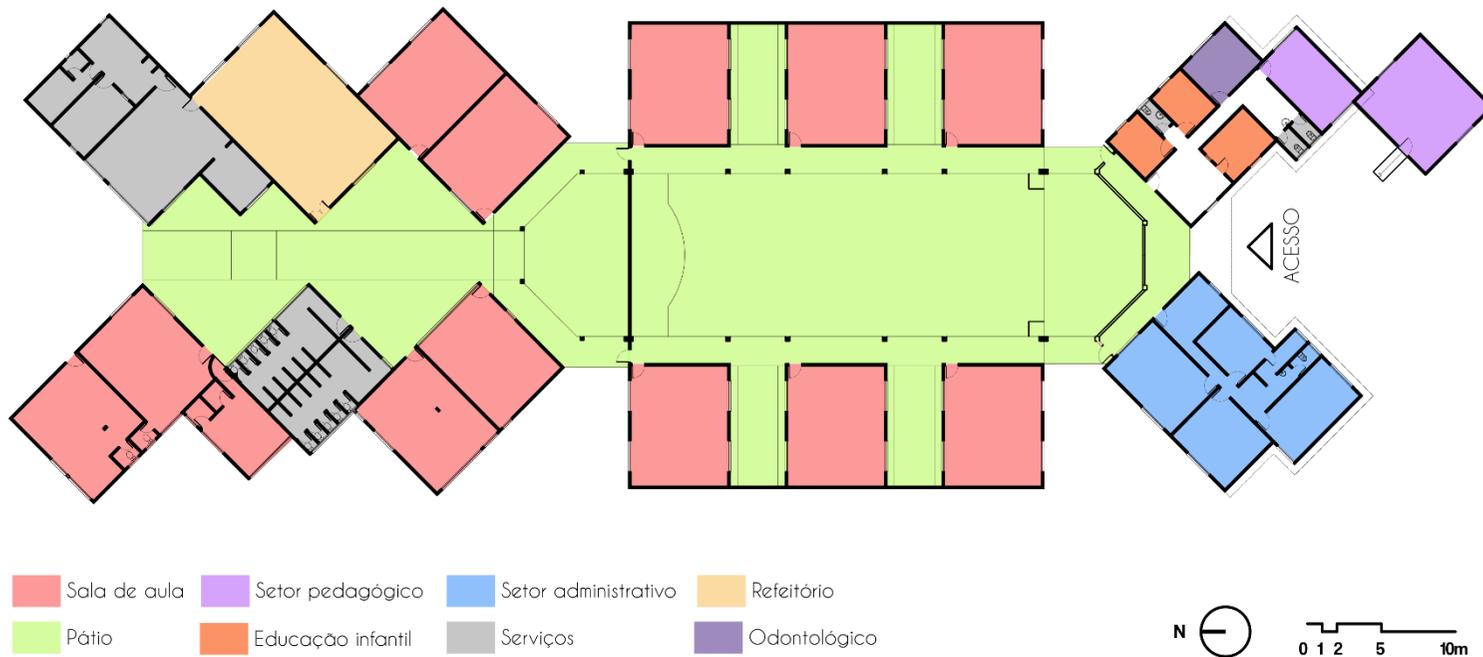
Planta baixa com zoneamento por cores do CEAI João Pereira de Assis. Fonte: A autora.
